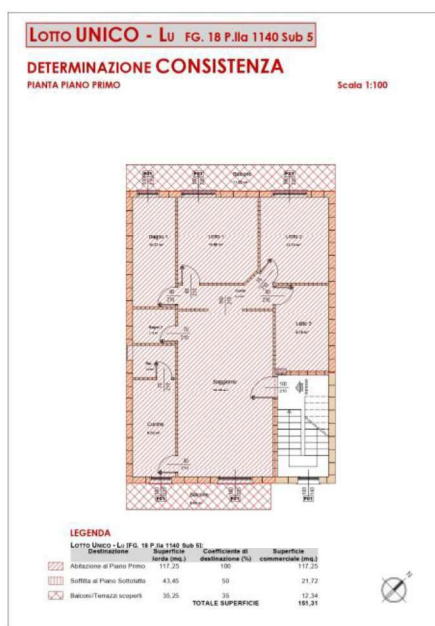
Determinazione consistenza Lotto LU – P. P. (ALL. 11).
